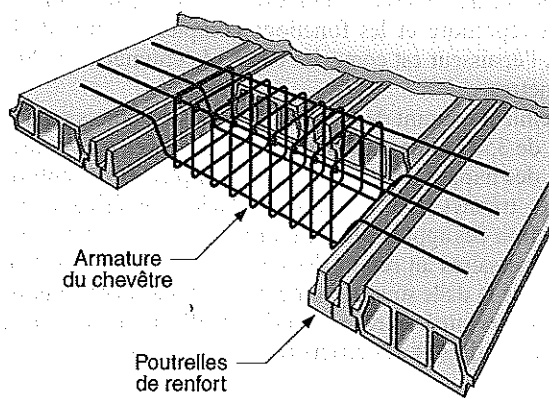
Plan de montage des planchers à poutrelles préfabriquées.
